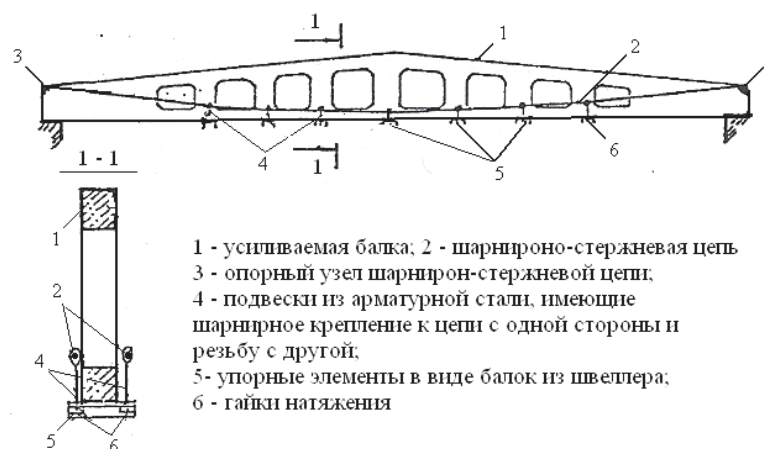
Усиление железобетонных стропильных балок установкой шарнирно-стержневой цепи с подвесками
